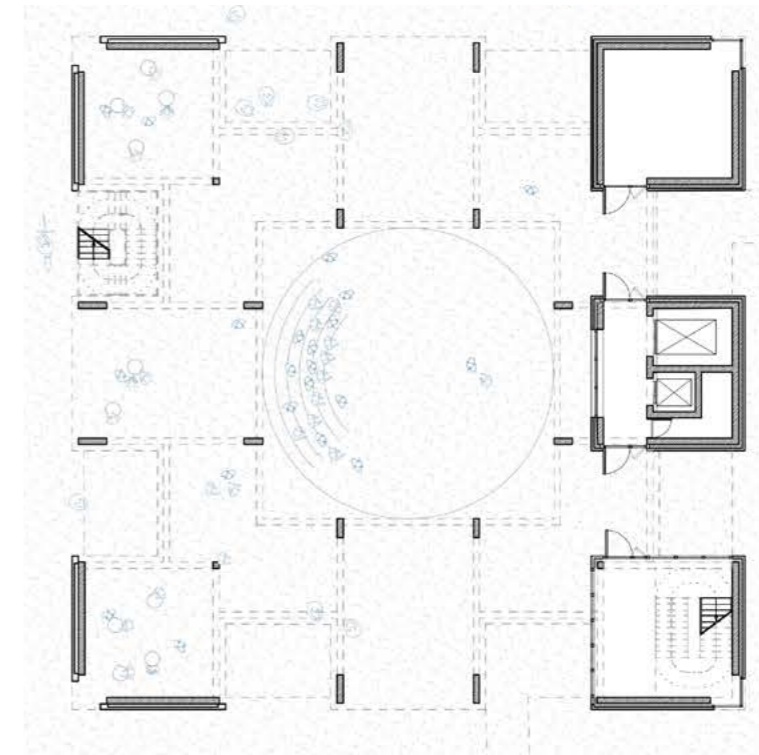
Rez-de-chaussée: l'intervention isolée.
